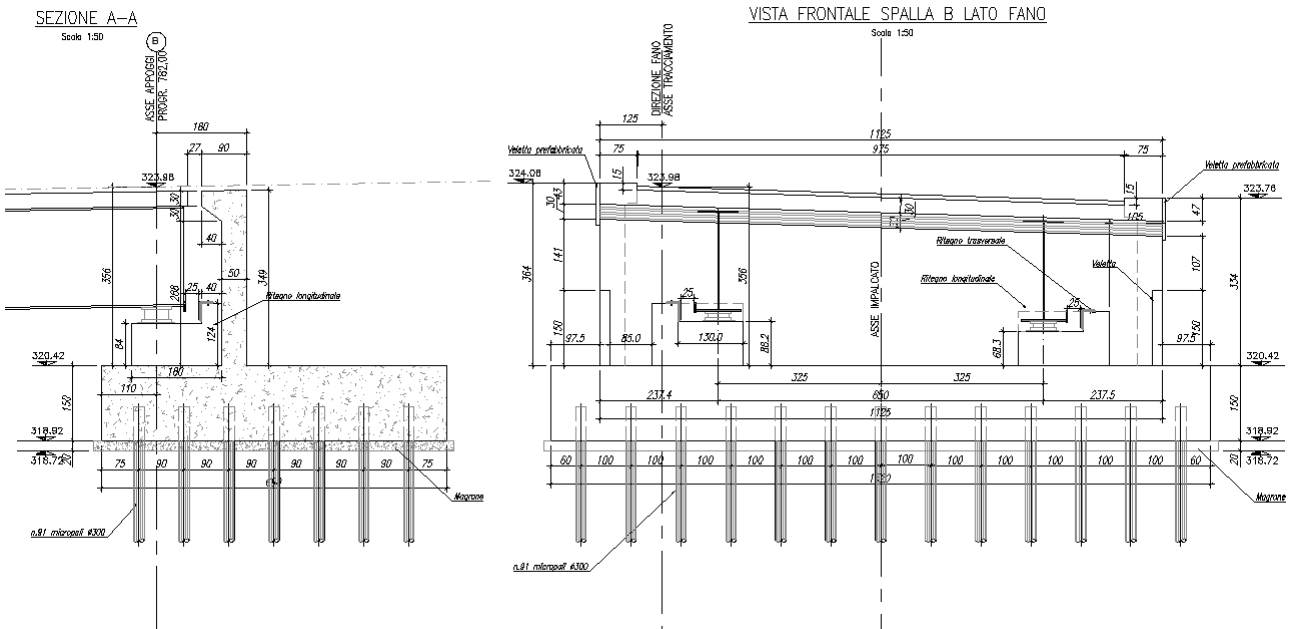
Spalla B (Sezione e prospetto).
